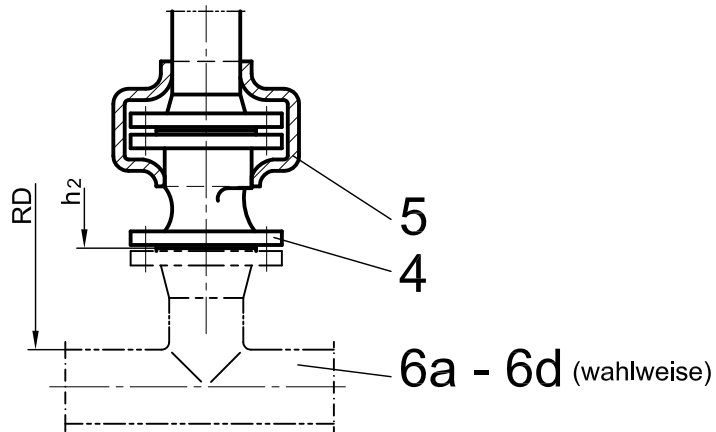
Hydrant DN 80 mit unterem Anschluss – Darstellung Typ AD 1 (zweiteilig)
